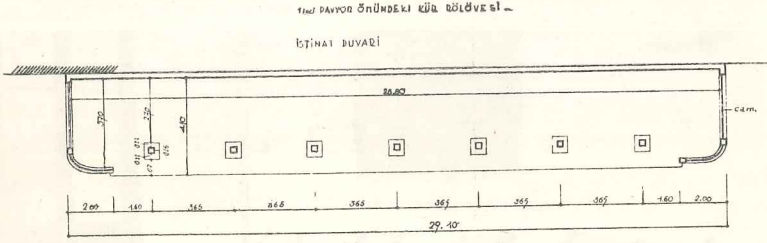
Birinci paviyon önünde yapılmış olan kür balkonu.
